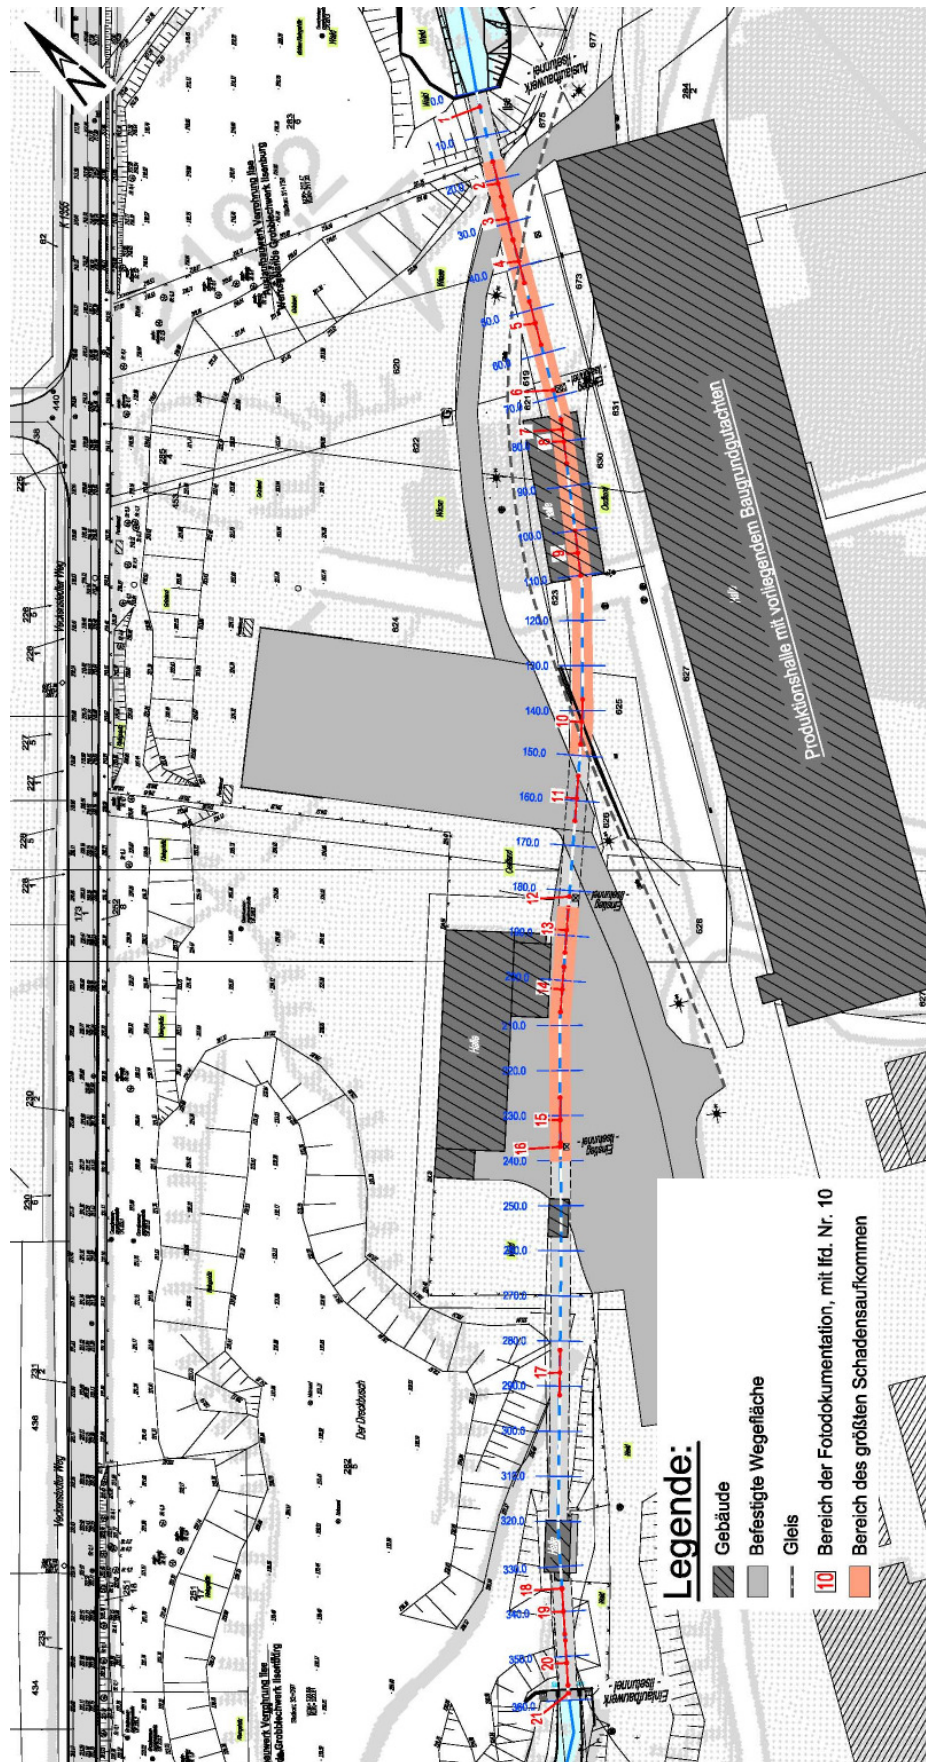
Lageplan mit Standpunkten der Fotodokumentation
